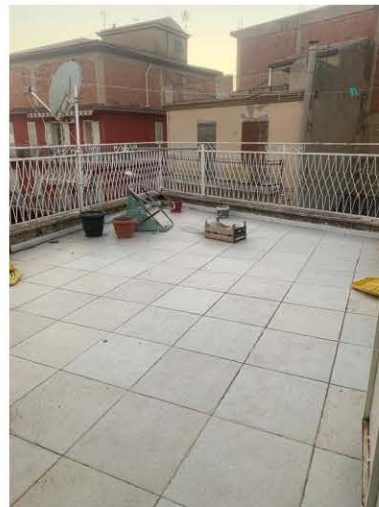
FOTO INTERNE SOTTOTETTO PIANO SECONDO
